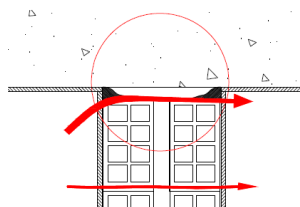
Parede de alvenaria de tijolo furado com insuficiência de argamassa nas juntas de assentamento (Mateus & Pereira, 2011)
